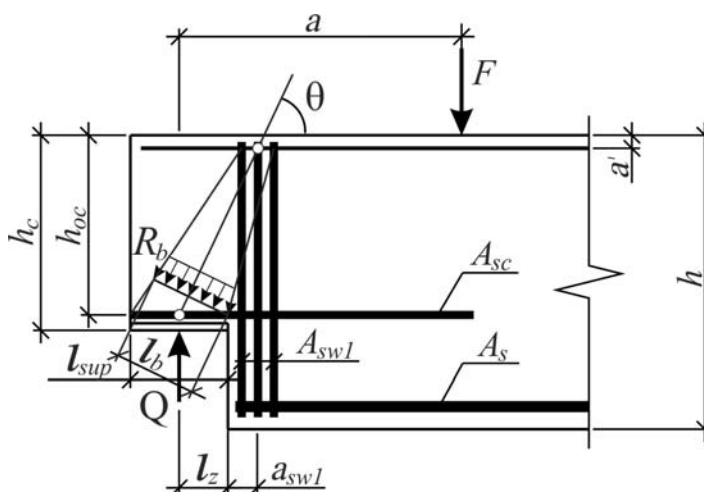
Расчетная модель сжатой полосы бетона опорной консоли ригеля
